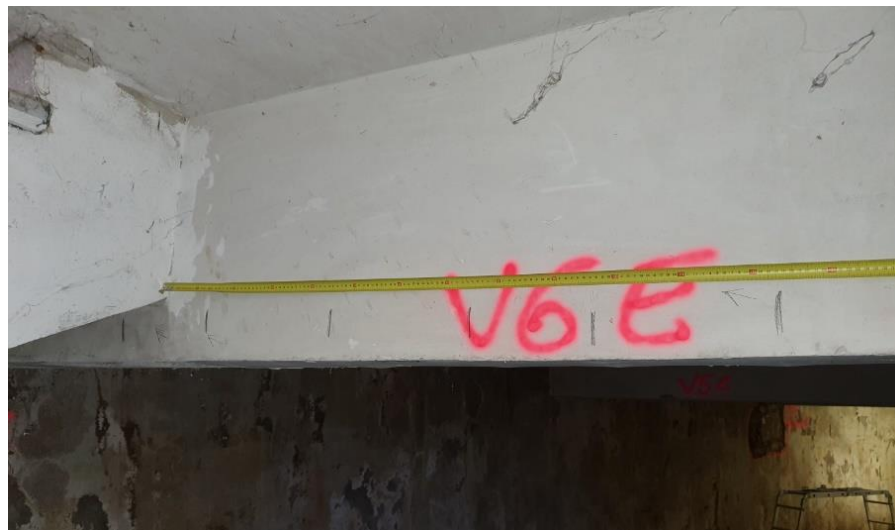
Pachometría realizada en una de las vigas de canto del escenario. Se comprobaron la distancia entre los estribos junto al apoyo de la viga en el muro.
